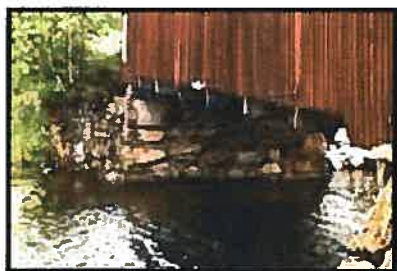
Le pont Narrow (61-69-03) dont la culée est construite de pierres empilées.
